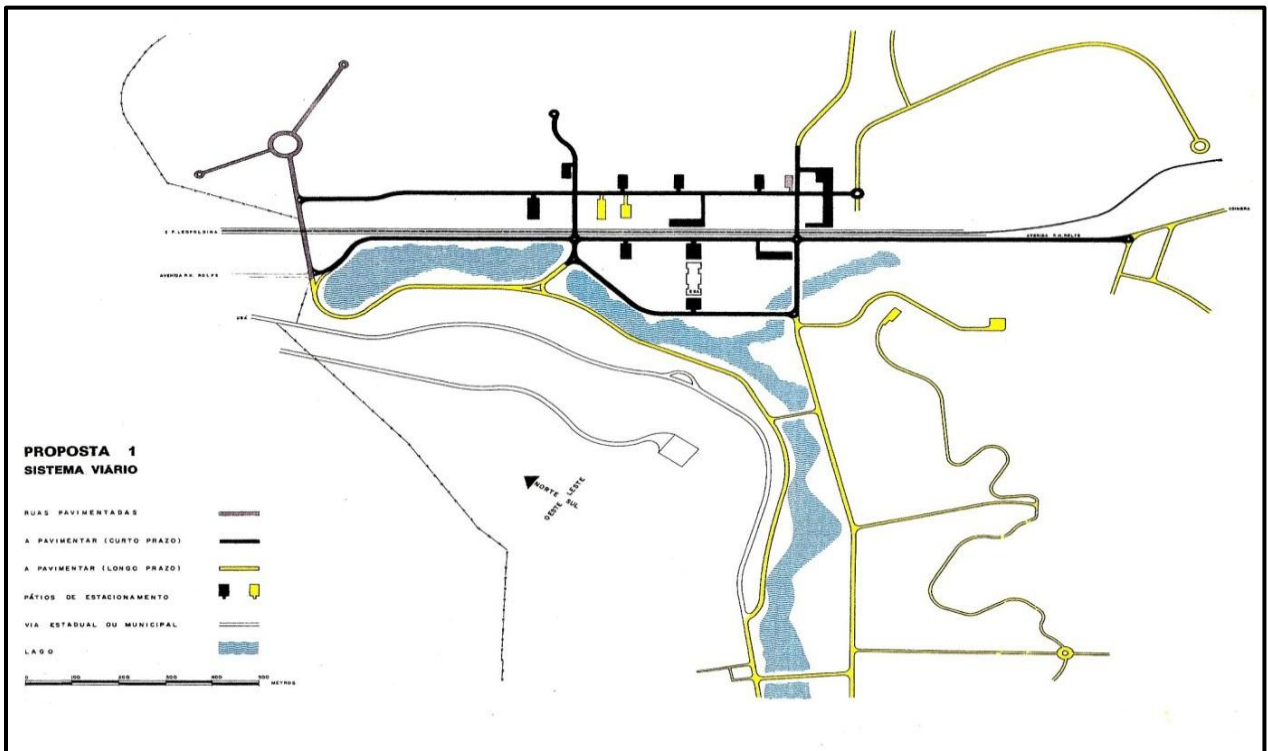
Proposta do sistema viário demonstrando grandes áreas pavimentadas no Campus.
